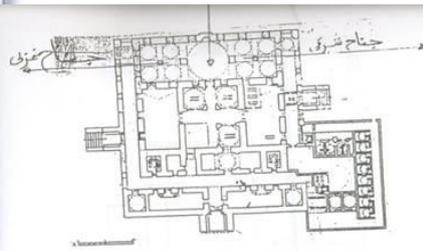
مسقط أفقي للجامع الكبير بصنعاء اليمن (عن كريزول).
